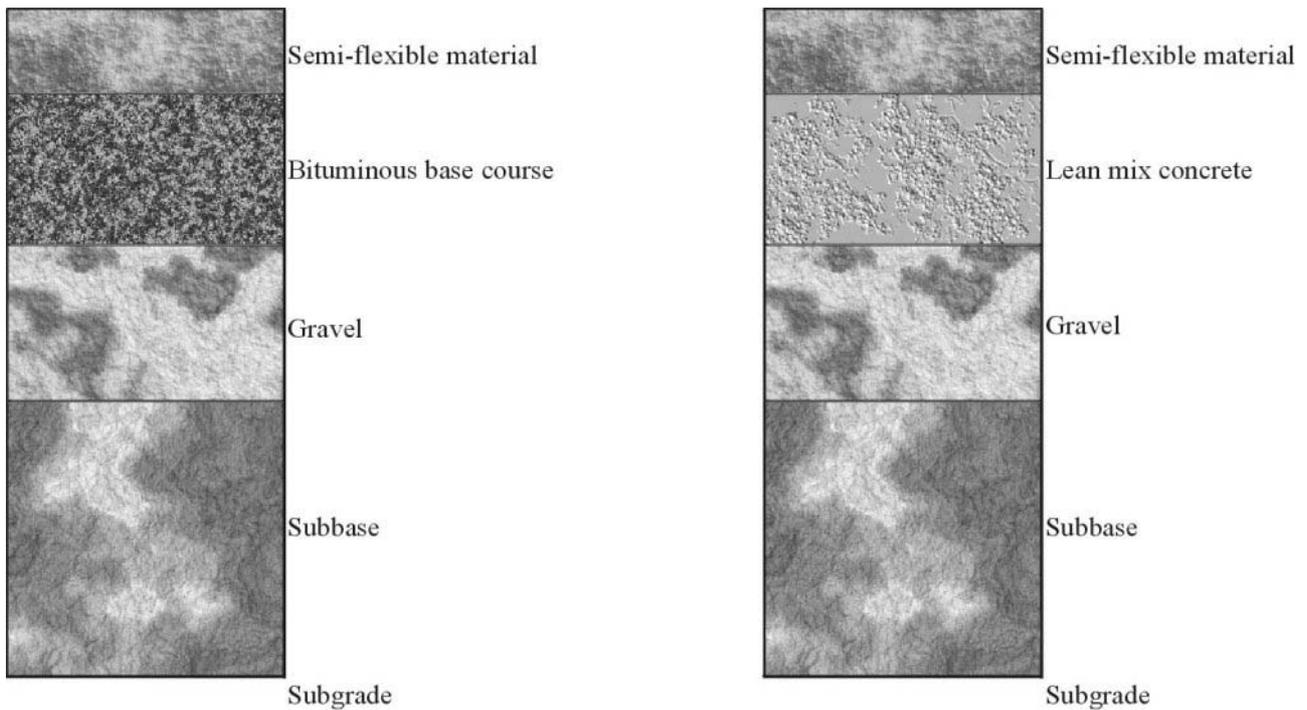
Exemples du design des revêtements semi-flexibles avec couche de base bitumineuse et béton maigre comme base.
